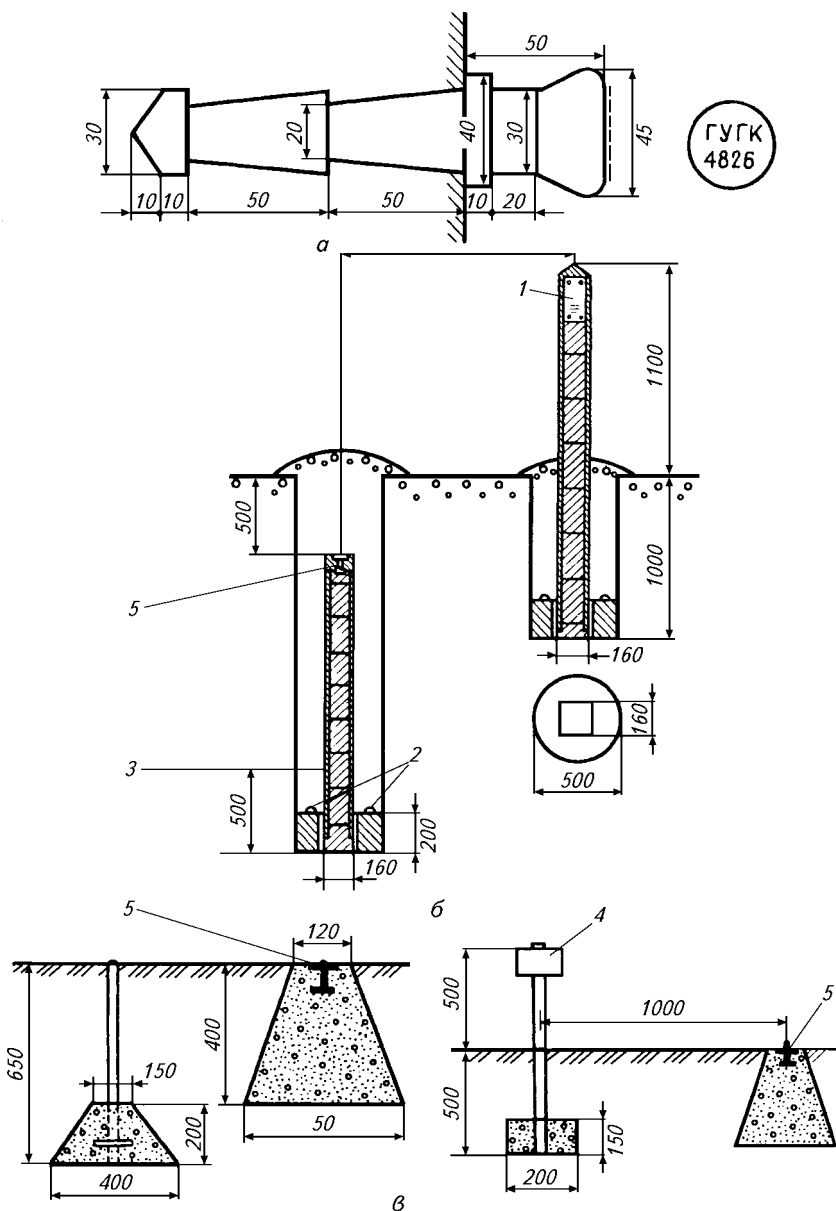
Стенной (а), грунтовой с маркой (б) реперы и железобетонный пилон с маркой и охранной табличкой (в):
